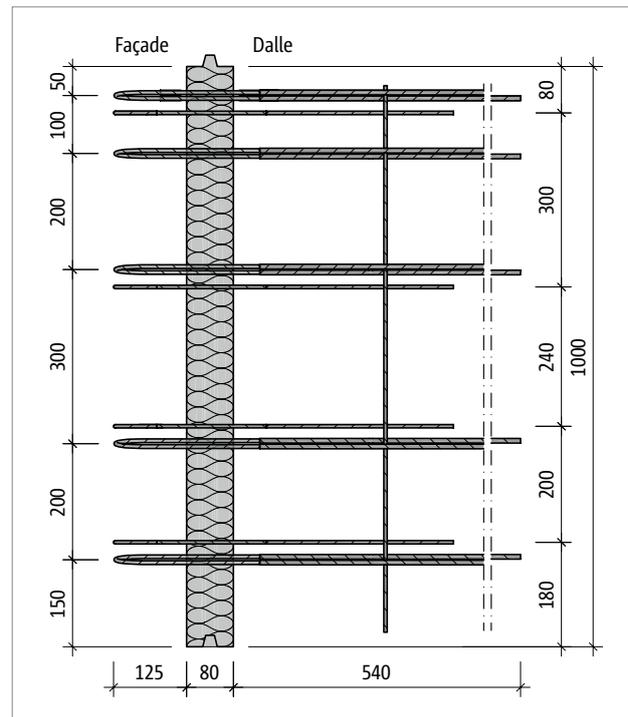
Schöck Rutherma® T type DF-V3-LR125 : vue en plan du produit
